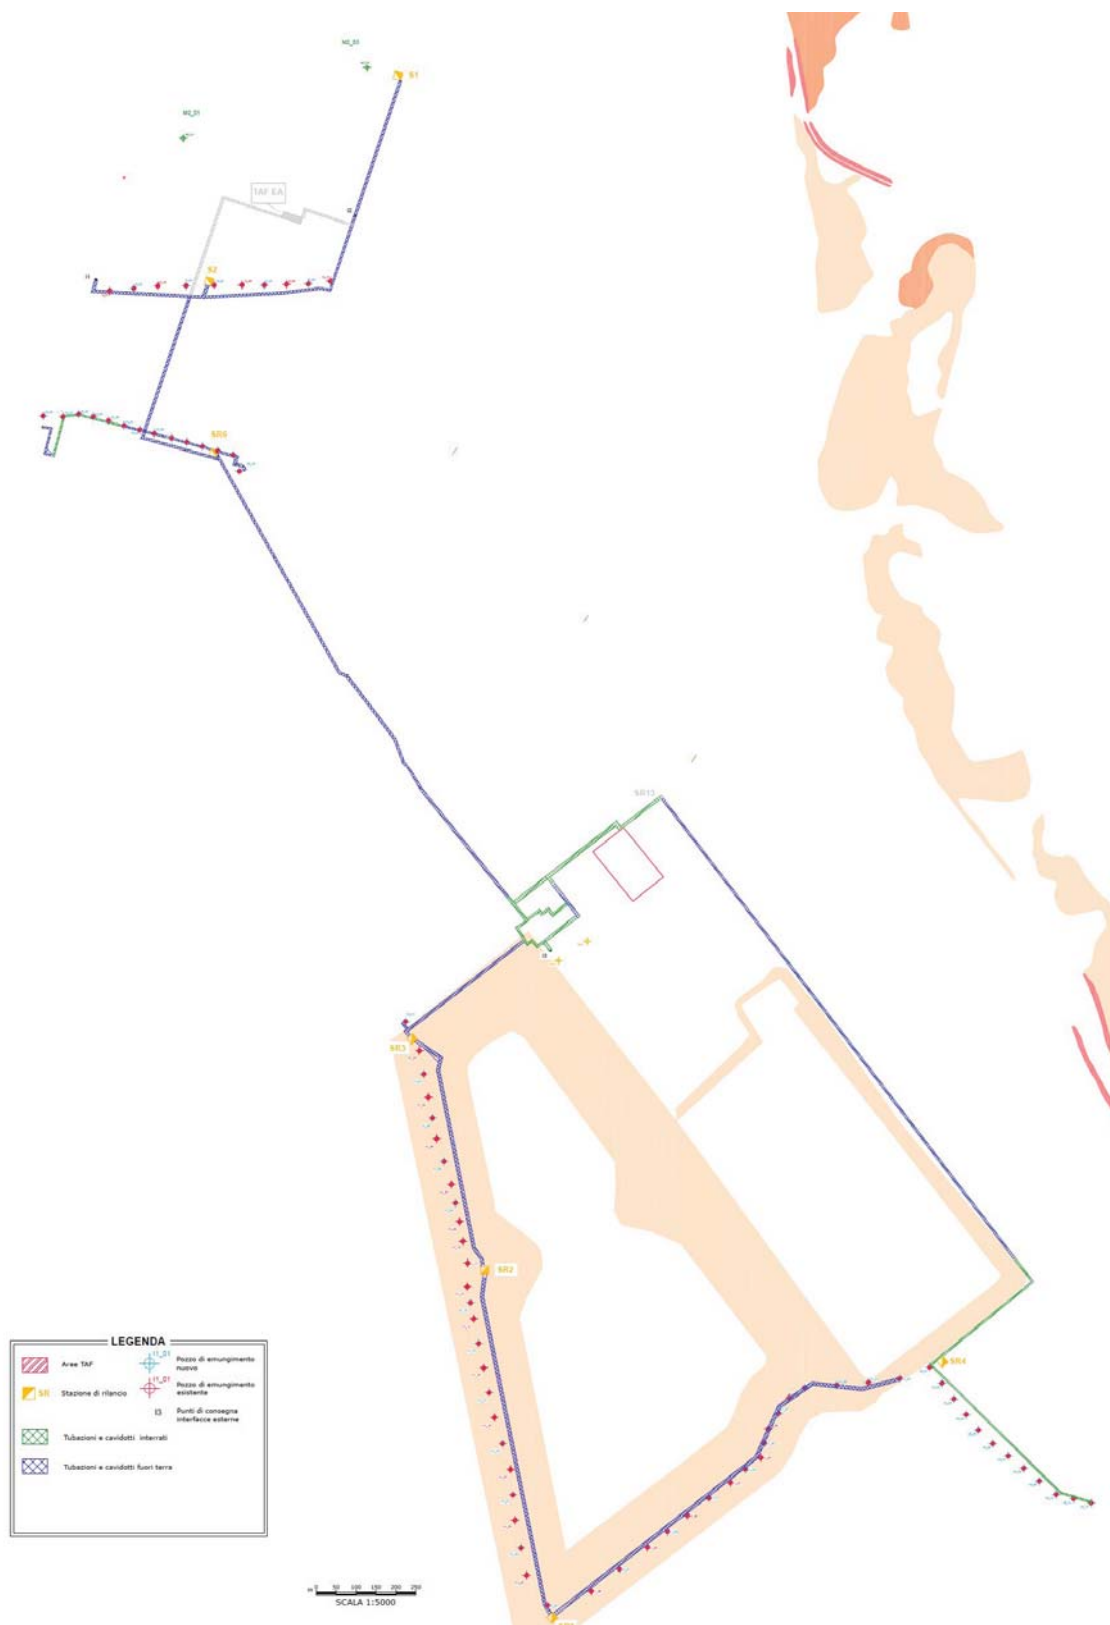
Planimetria con l'indicazione delle opere previste e la pericolosità geologica vigente
